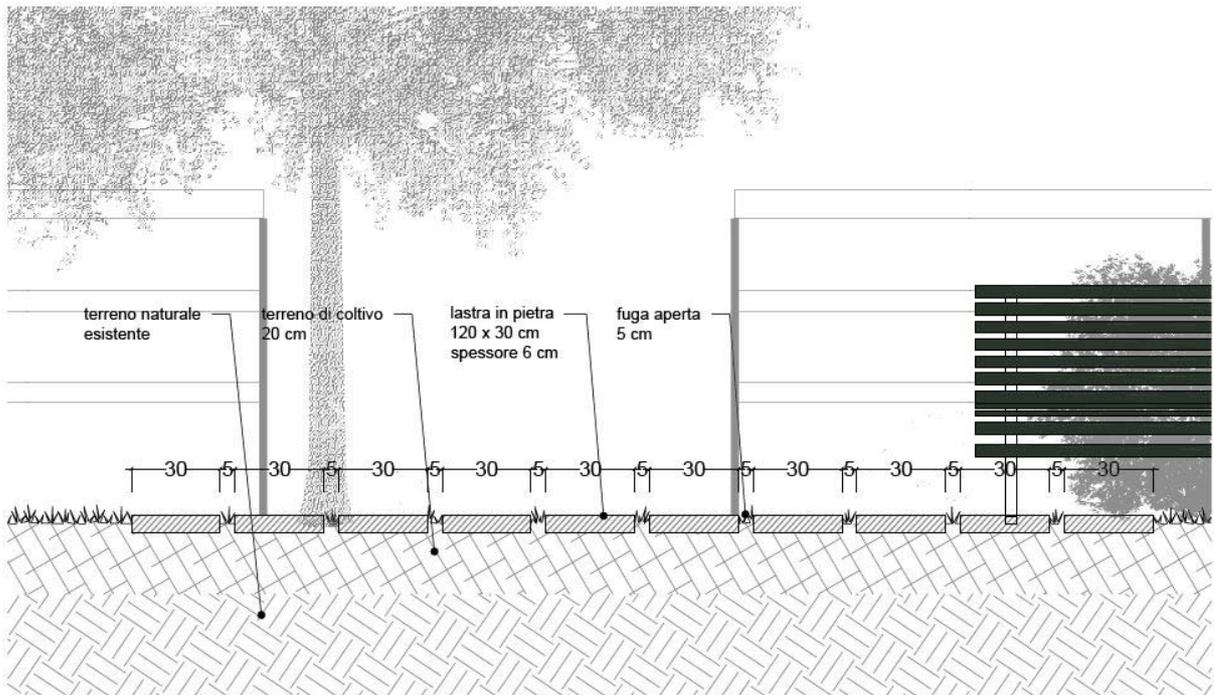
PROGETTO ESECUTIVO - Stralcio della tavola 0241, dettaglio posa della pavimentazione
